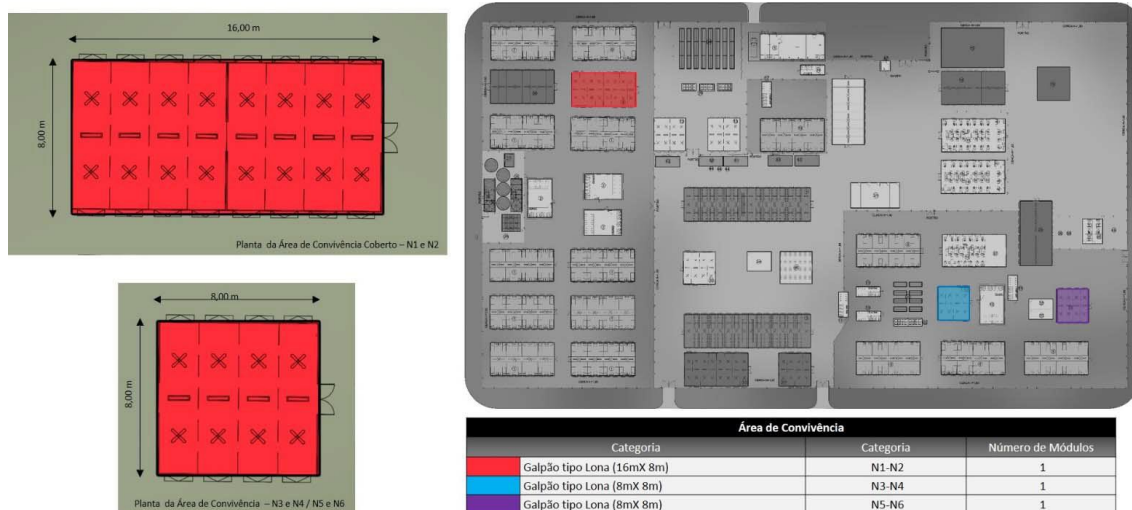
10 – Plantas e localização das Áreas de Convivência dentro do Canteiro Pioneiro conforme as categorias de mão de obra.
